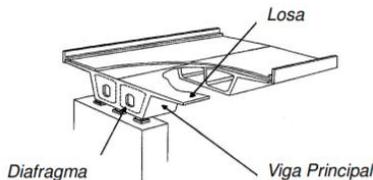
Sistema de viga cajón. Fuente: MOPT, (2007)
